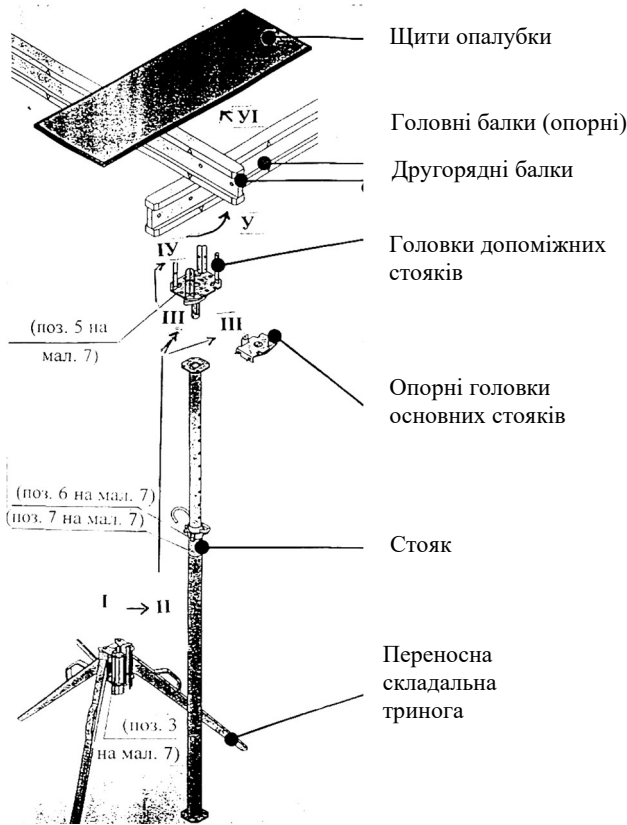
Схема елементів послідовного розташування горизонтальної опалубки
